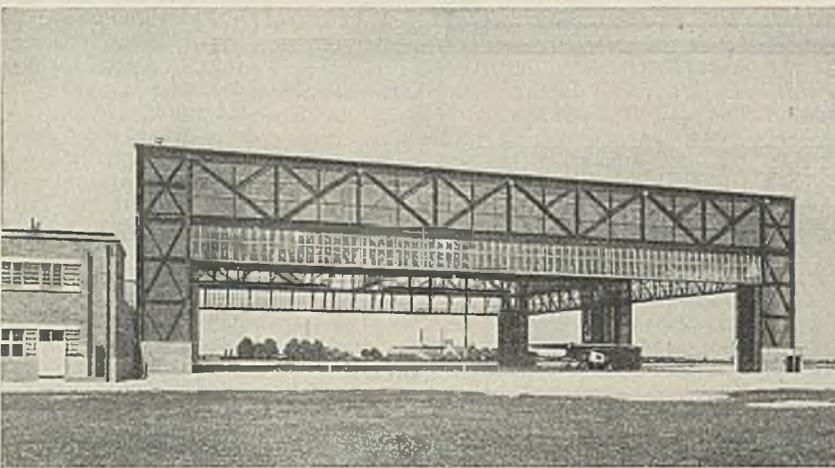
Flugzeughalle Abb. 10 mit auf drei Seiten geöffneten Toren.
